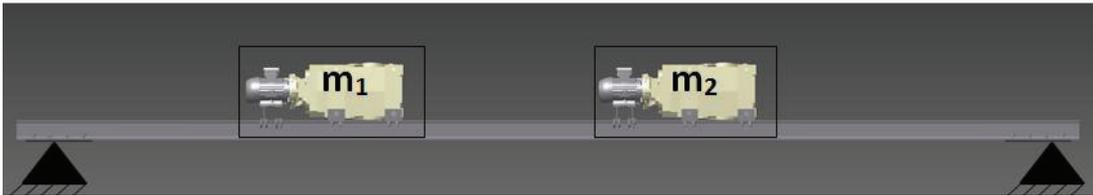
Esquema de cargas aplicadas sobre la viga.
